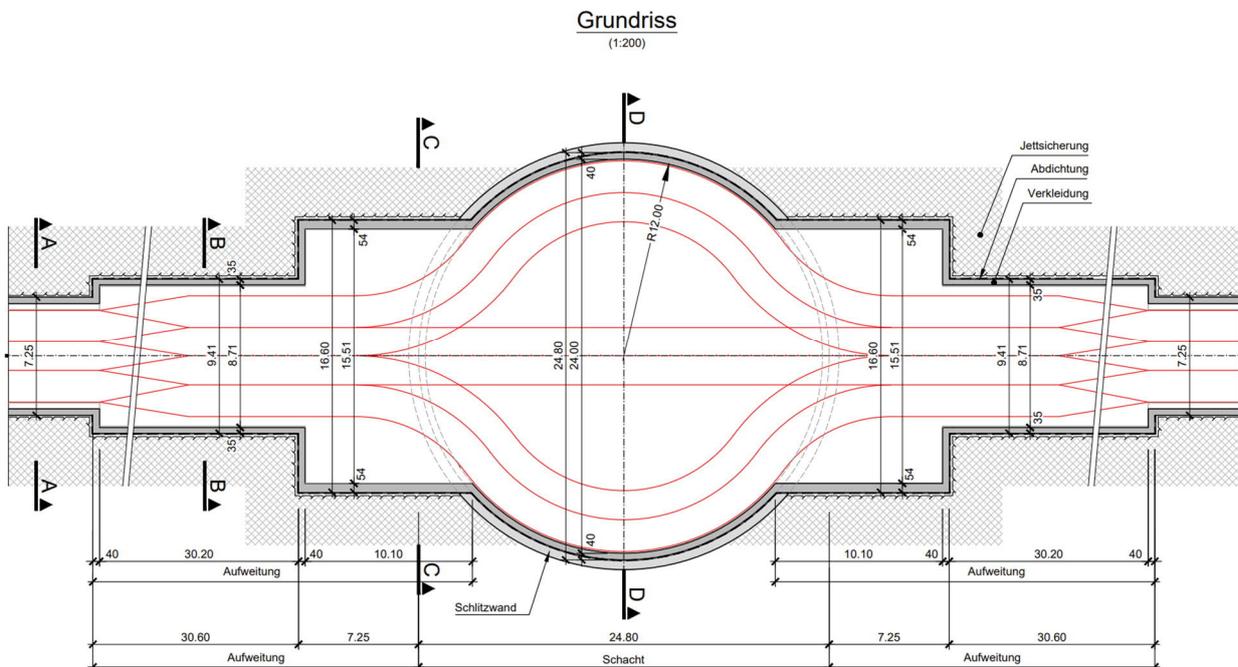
Darstellung eines Hubschachtes und der Anbindung an den Tunnel (Grundriss)
